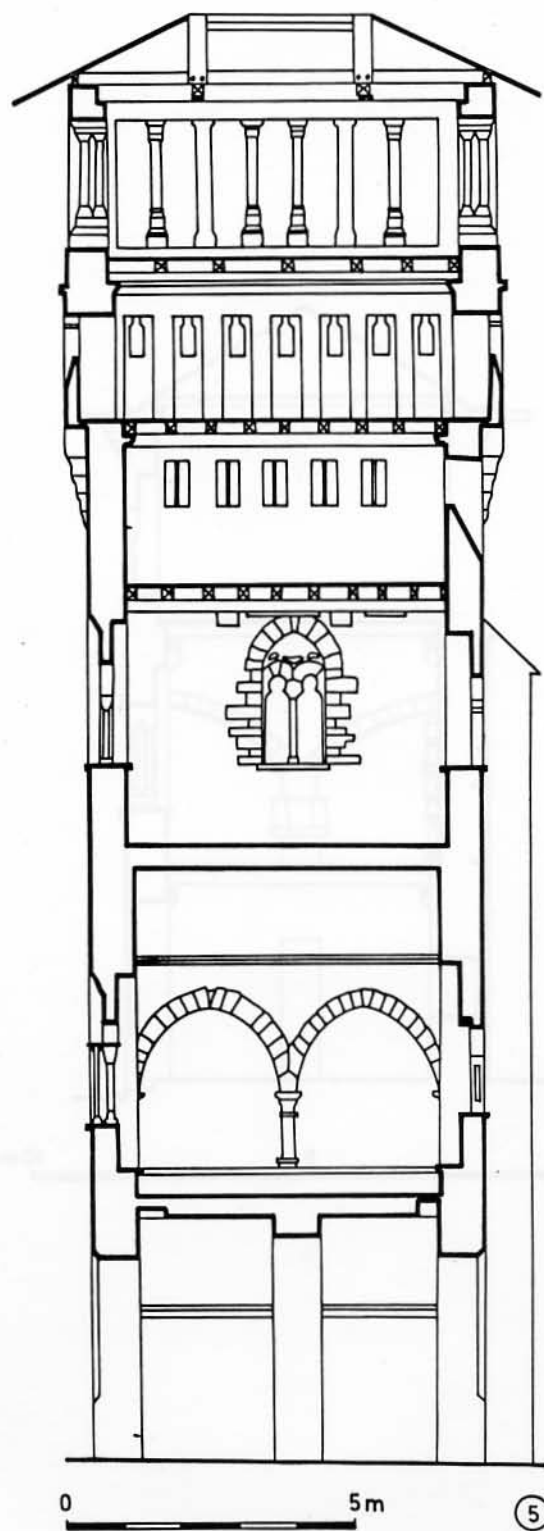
COUPE TRANSVERSALE DE LA TOUR ET ELEVATION INTERIEURE DU MUR SUD (Relevé P. Roques, Inventaire Général).
